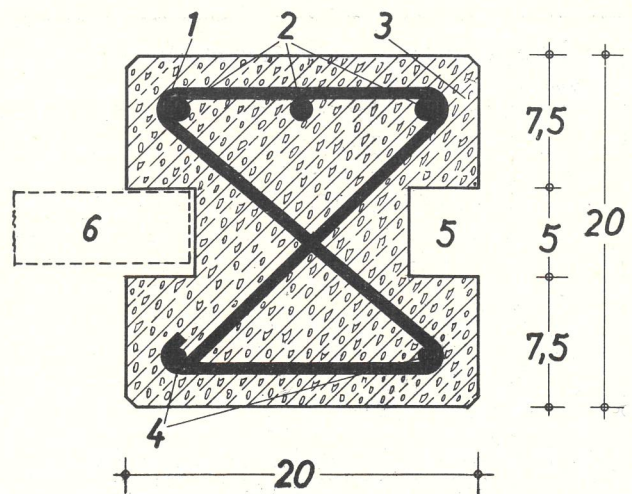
Schnittzeichnung des Betonpfostens; 1 = Stahlbügel, 2 = Hauptbewehrung, 3 = Beton, 4 = Montageeisen, 5 = Aussparung, 6 = Wandbohlen.
